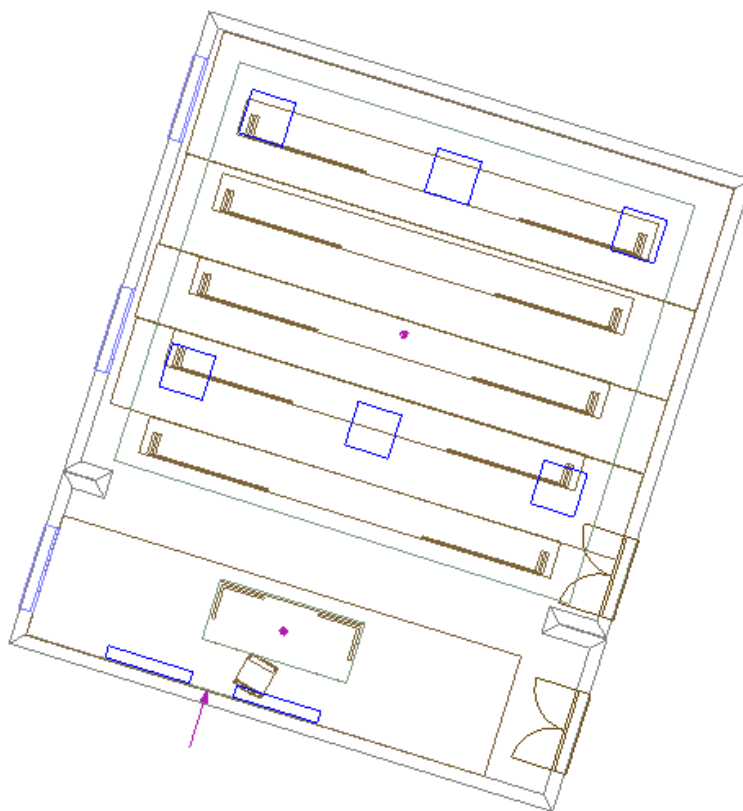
8: Aula 39 (Area 17) – Planimetria
